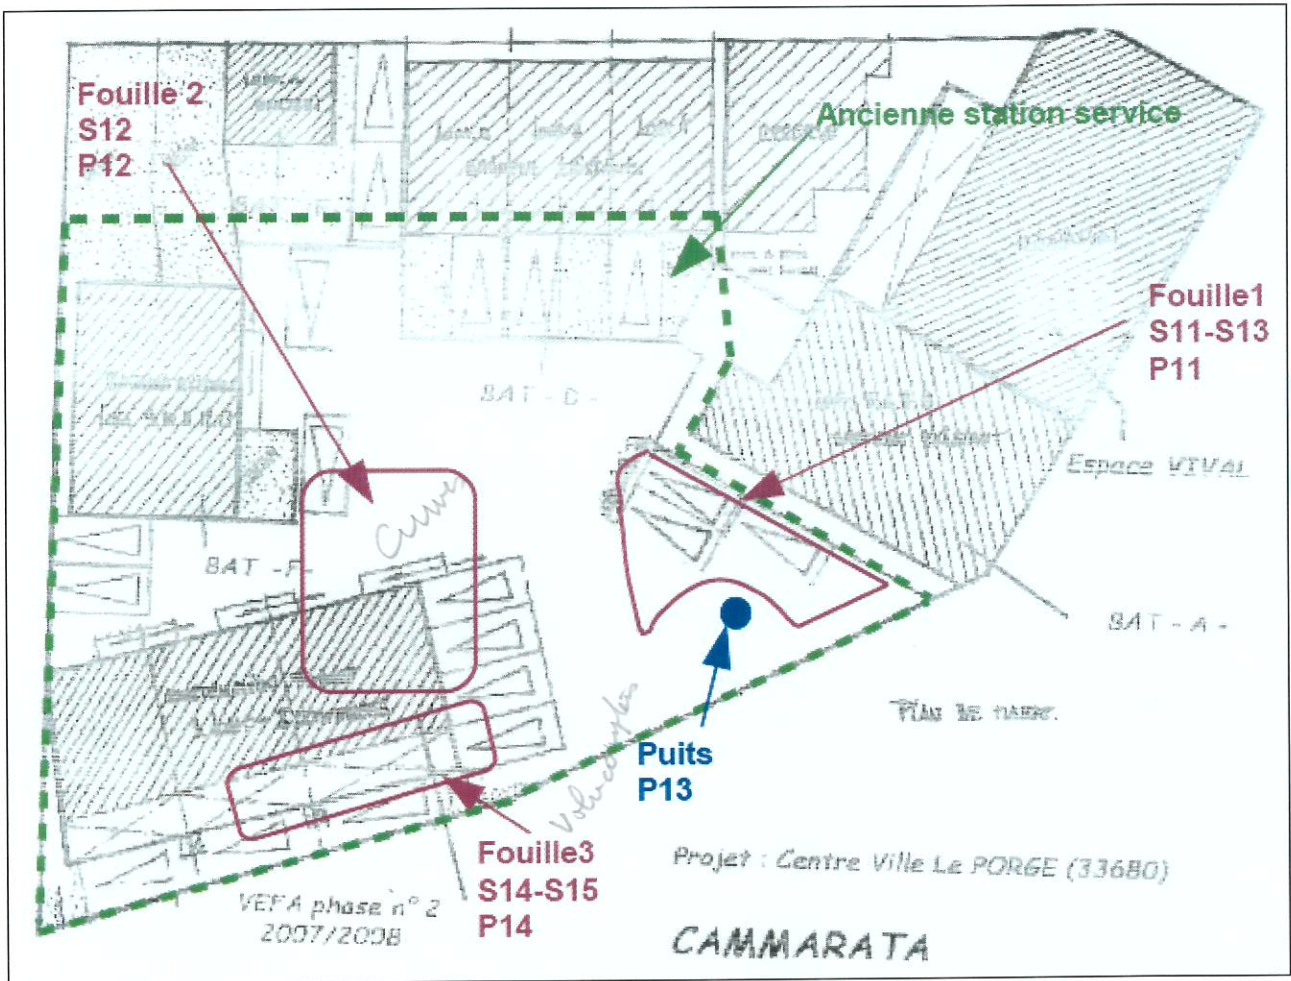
cartographie des interventions sur fond de plan du projet futur
